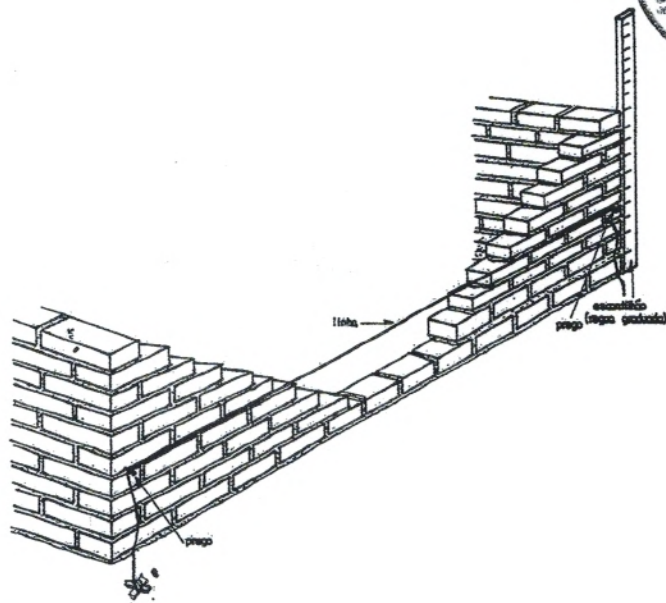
Execução de alvenaria utilizando tijolos furados.
